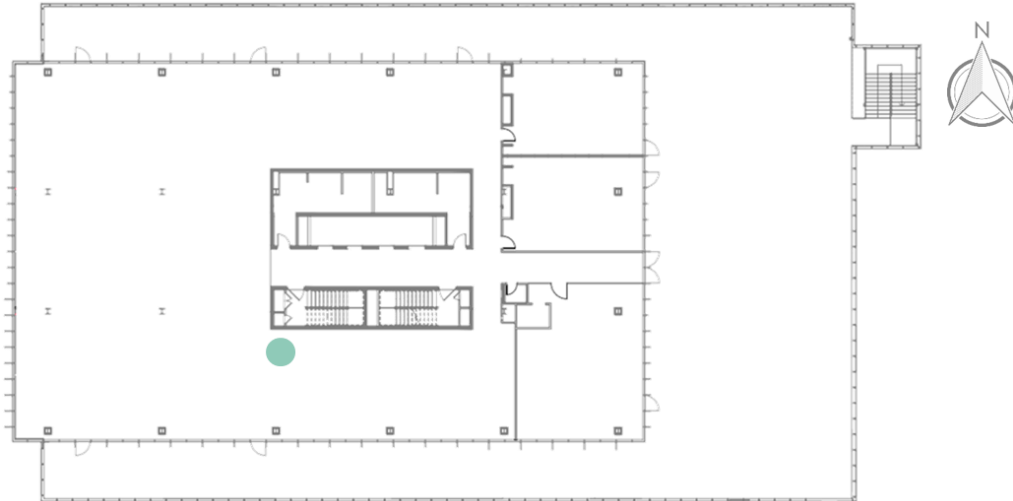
Planta arquitectónica nivel 07 | ubicación de equipos HOBO.
